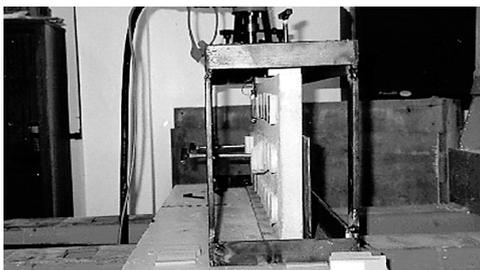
Substrato fixado ao suporte, pronto para o ensaio
